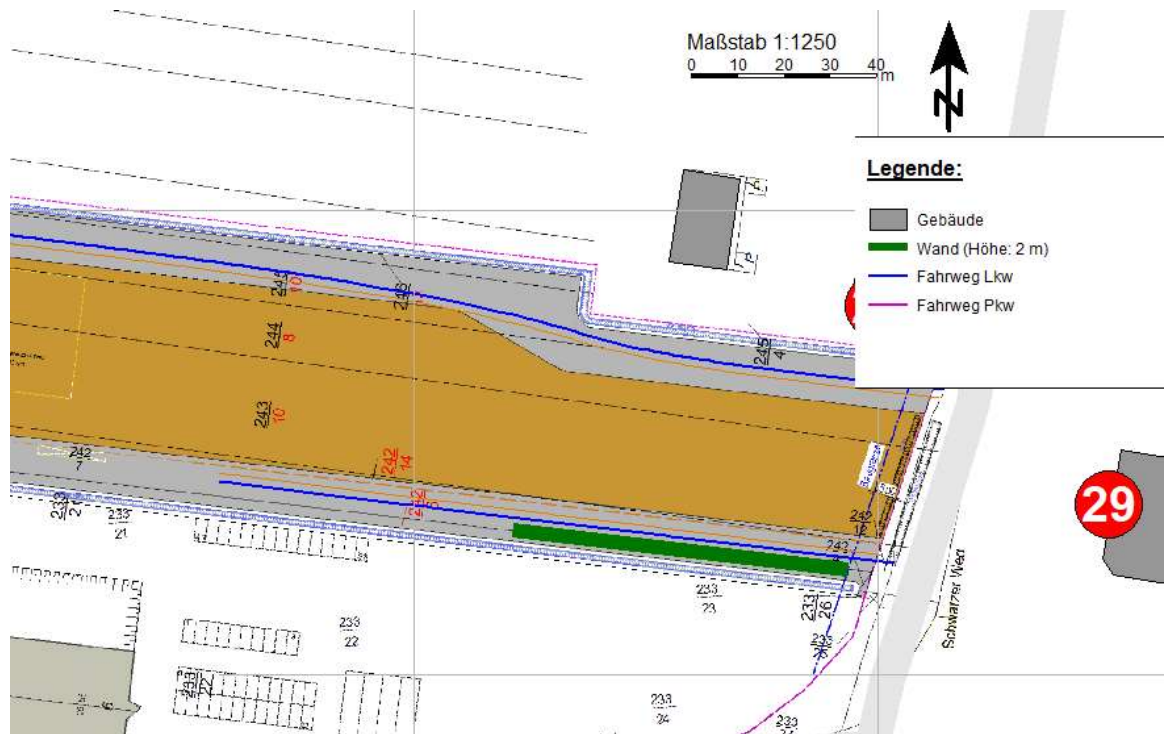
Lage der Wand; Quelle: SoundPLAN
